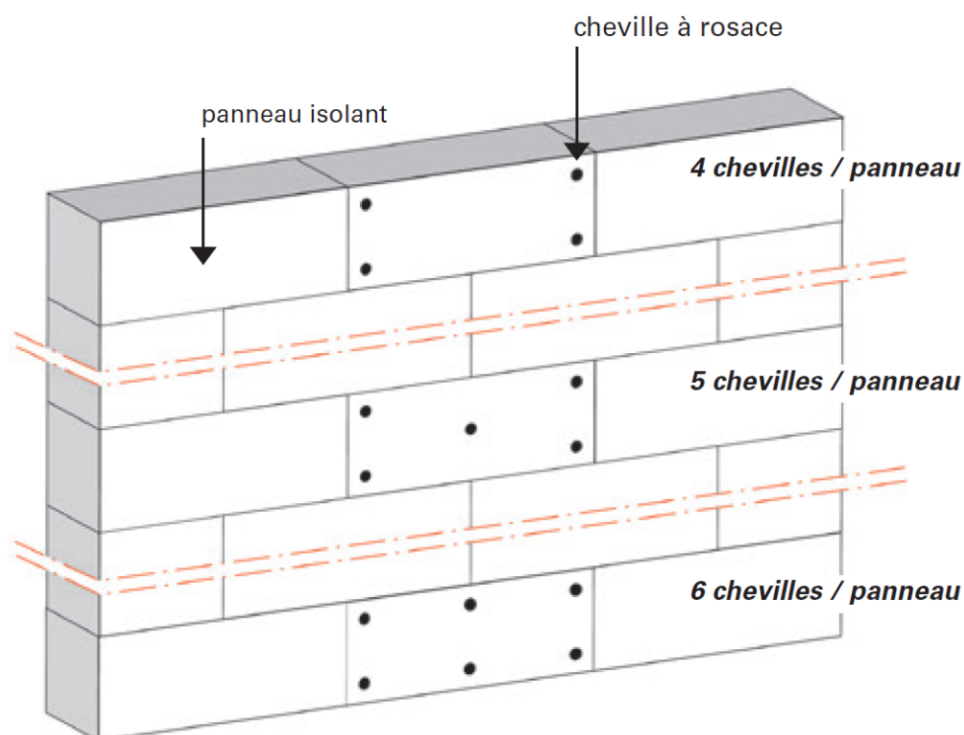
Fixation des panneaux isolants par chevilles ou clous – Disposition en plein (exemples)
